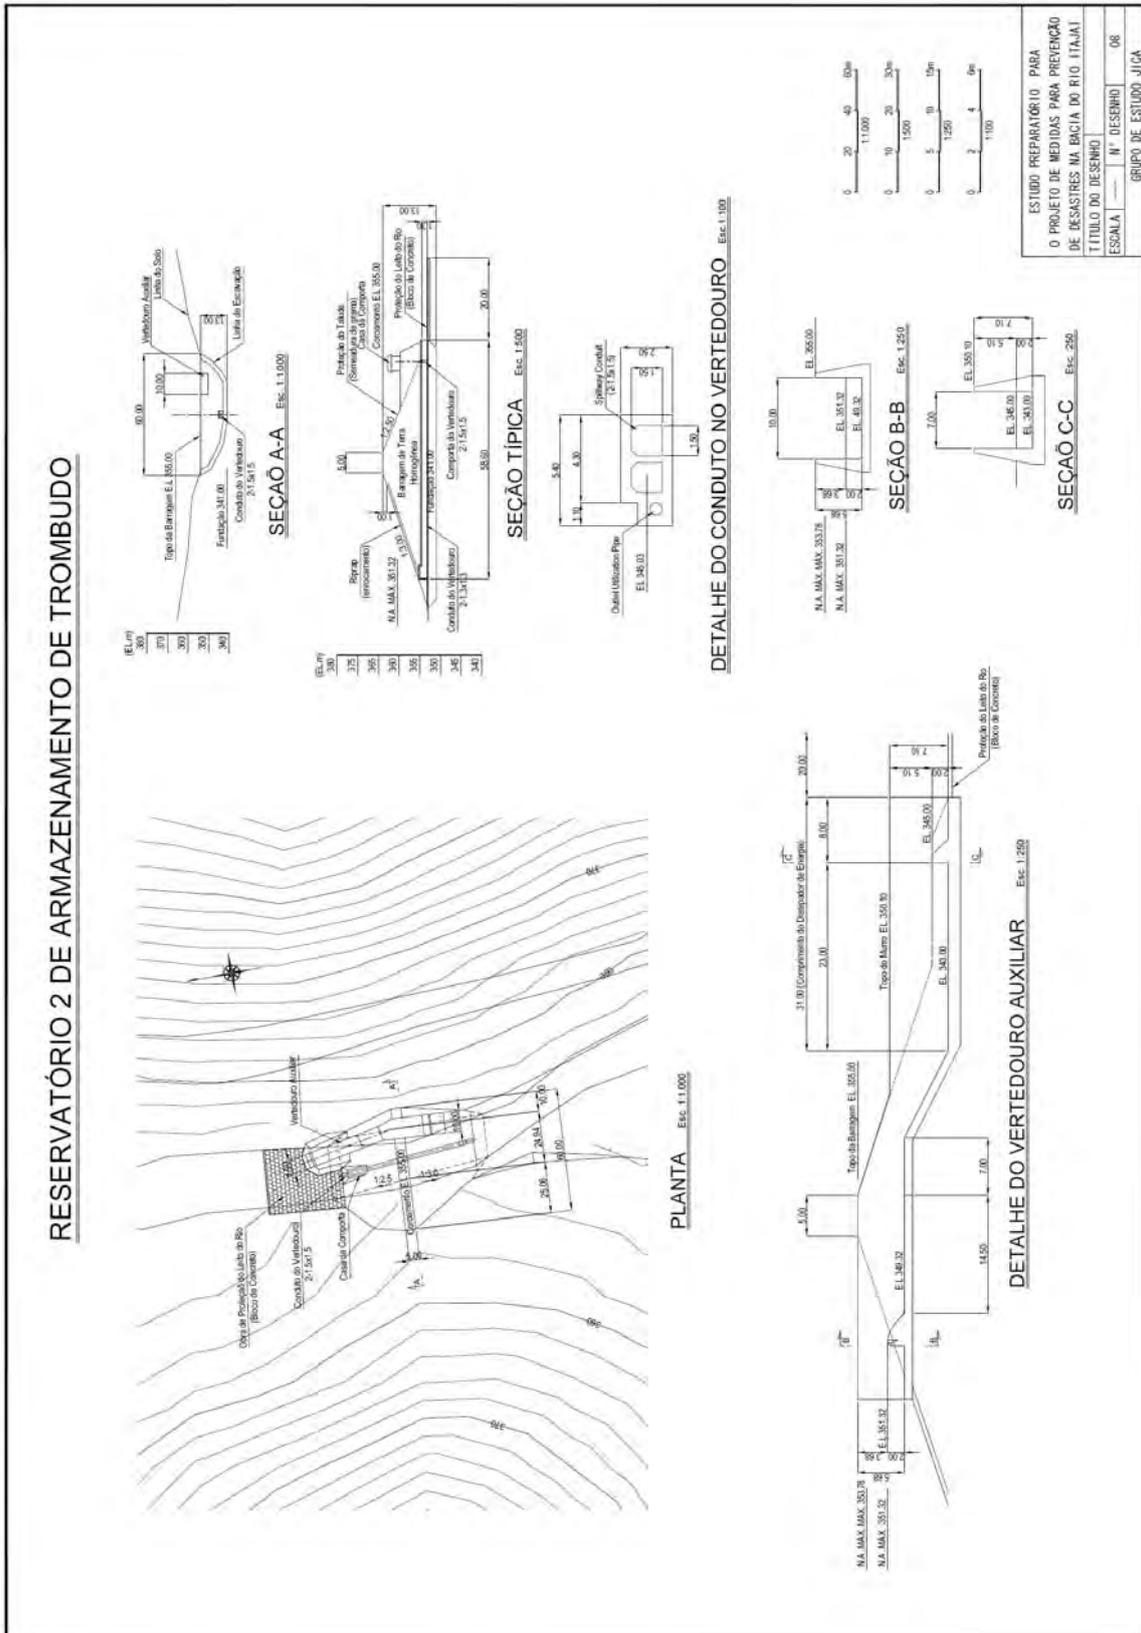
Projeto estrutural da barragem de pequeno porte – Trombudo 2 (reservatório de retenção)
